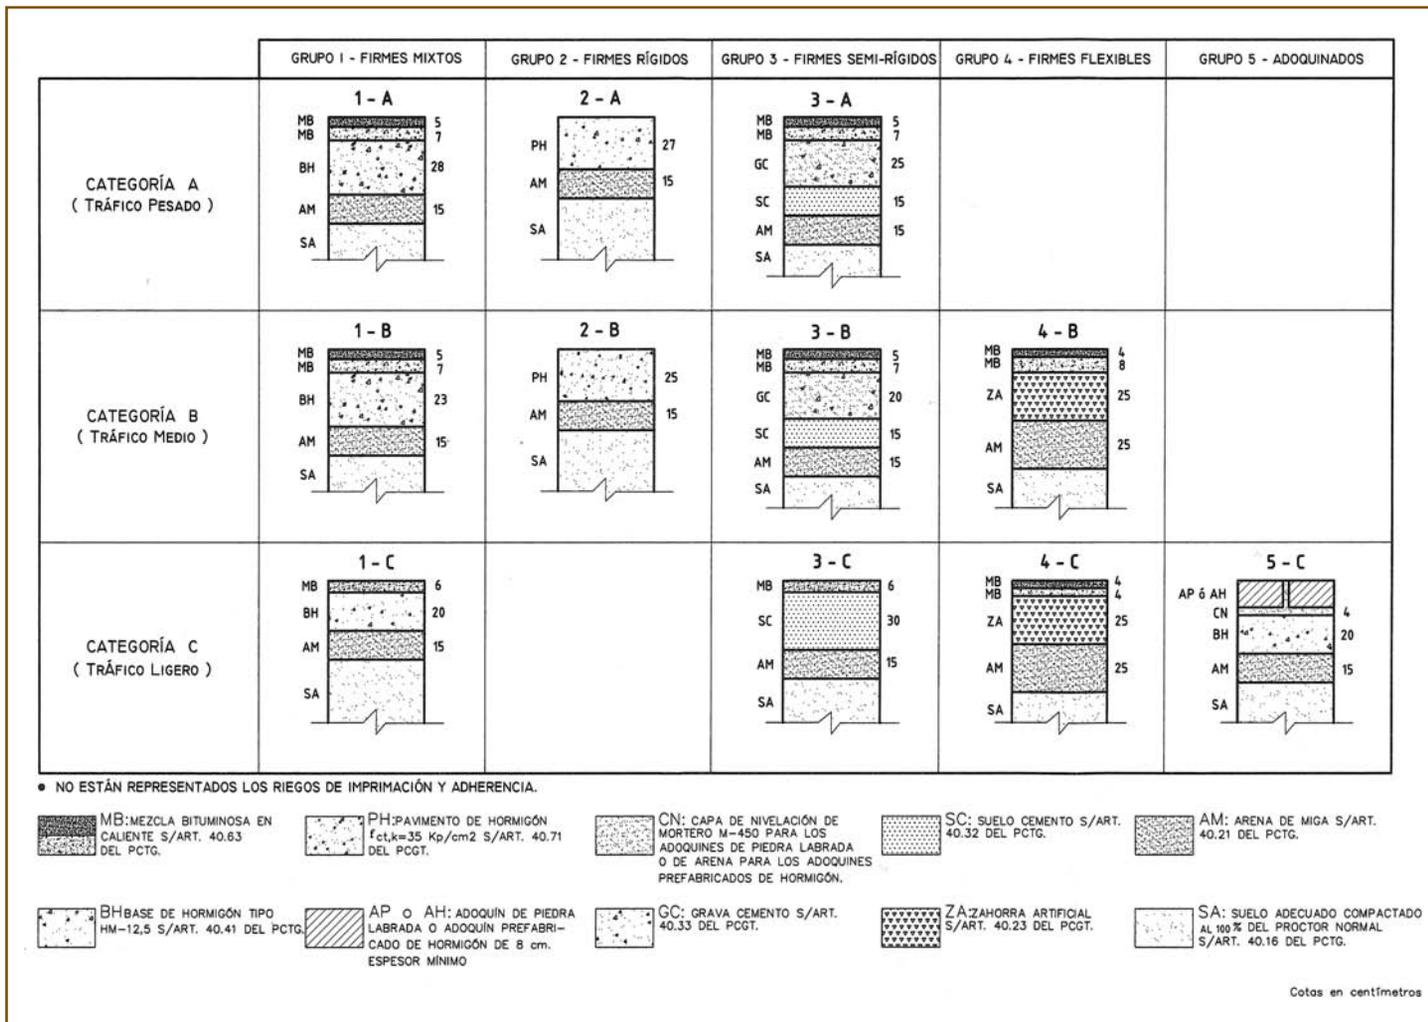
Secciones estructurales de firmes de calzadas. Tipos.
